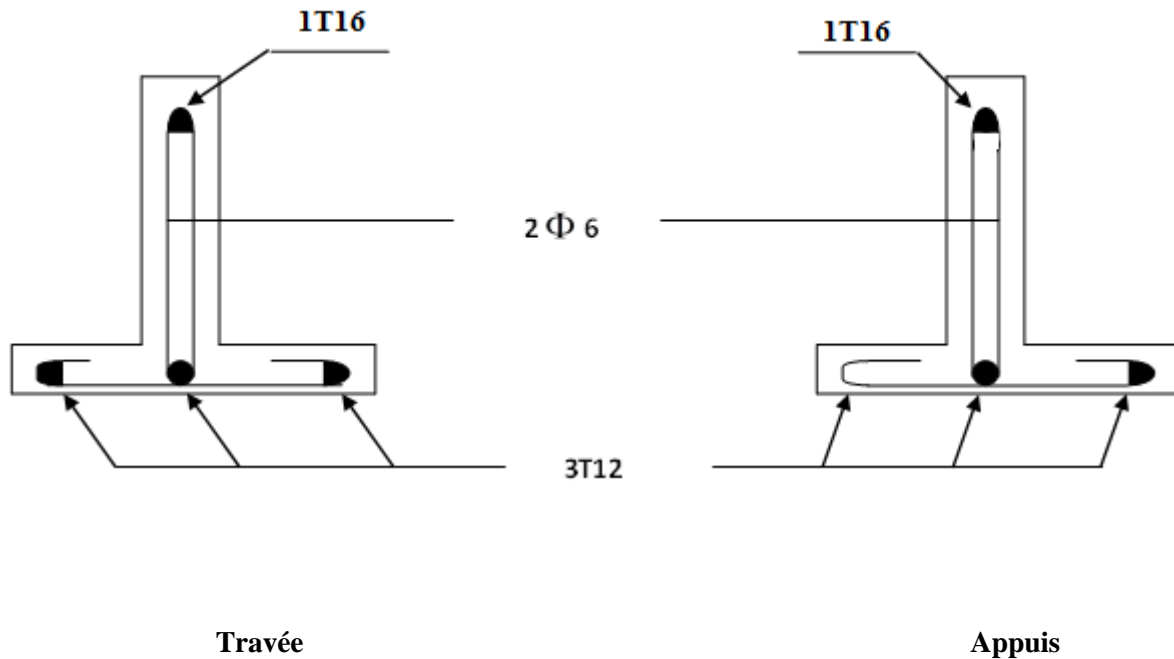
Disposition constructive des armatures des poutrelles à 2 travées
